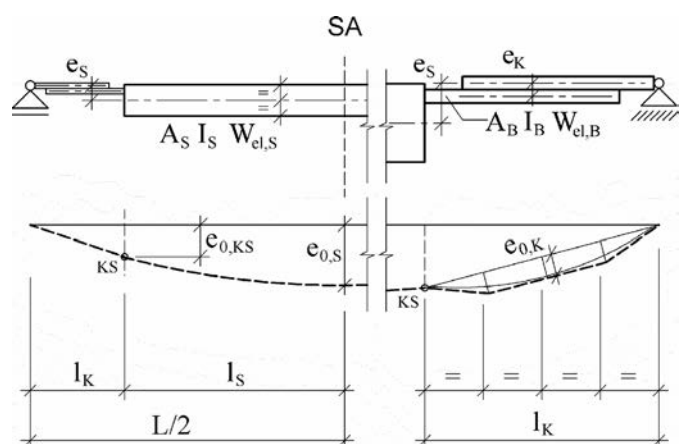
Fachwerkstab mit einfachem exzentrischen Anschluss und äquivalenter Ersatzimperfection
